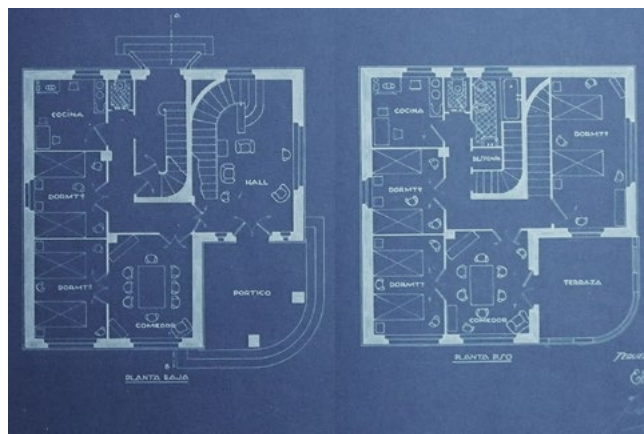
Planta del proyecto para el chalet de Fernando Hué. (1932). Fuente: AMT, Cod. 3-1-2-5. Sig. 2666-12.
